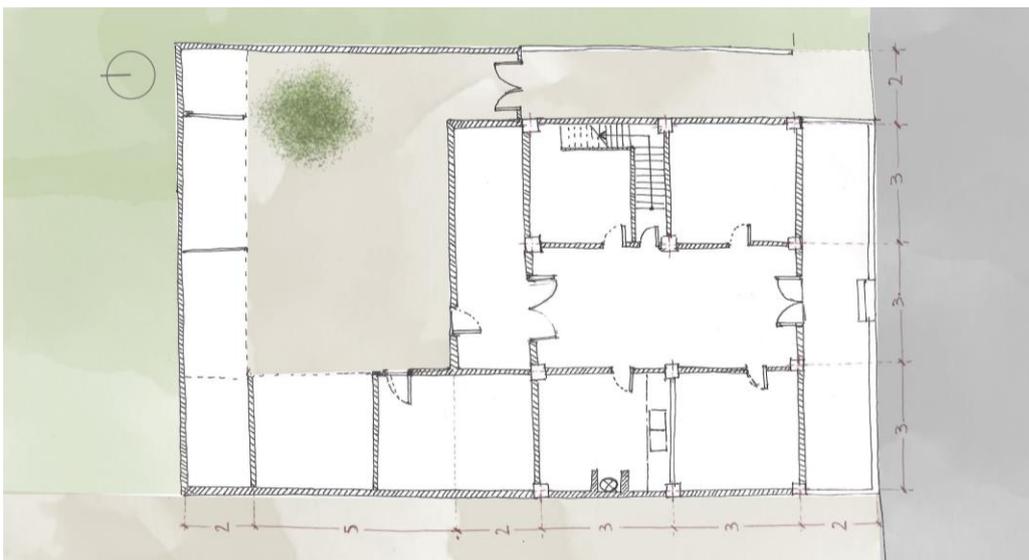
Planta vivienda tipo Huerta de Valencia (elaboración propia, cotas en metros)
